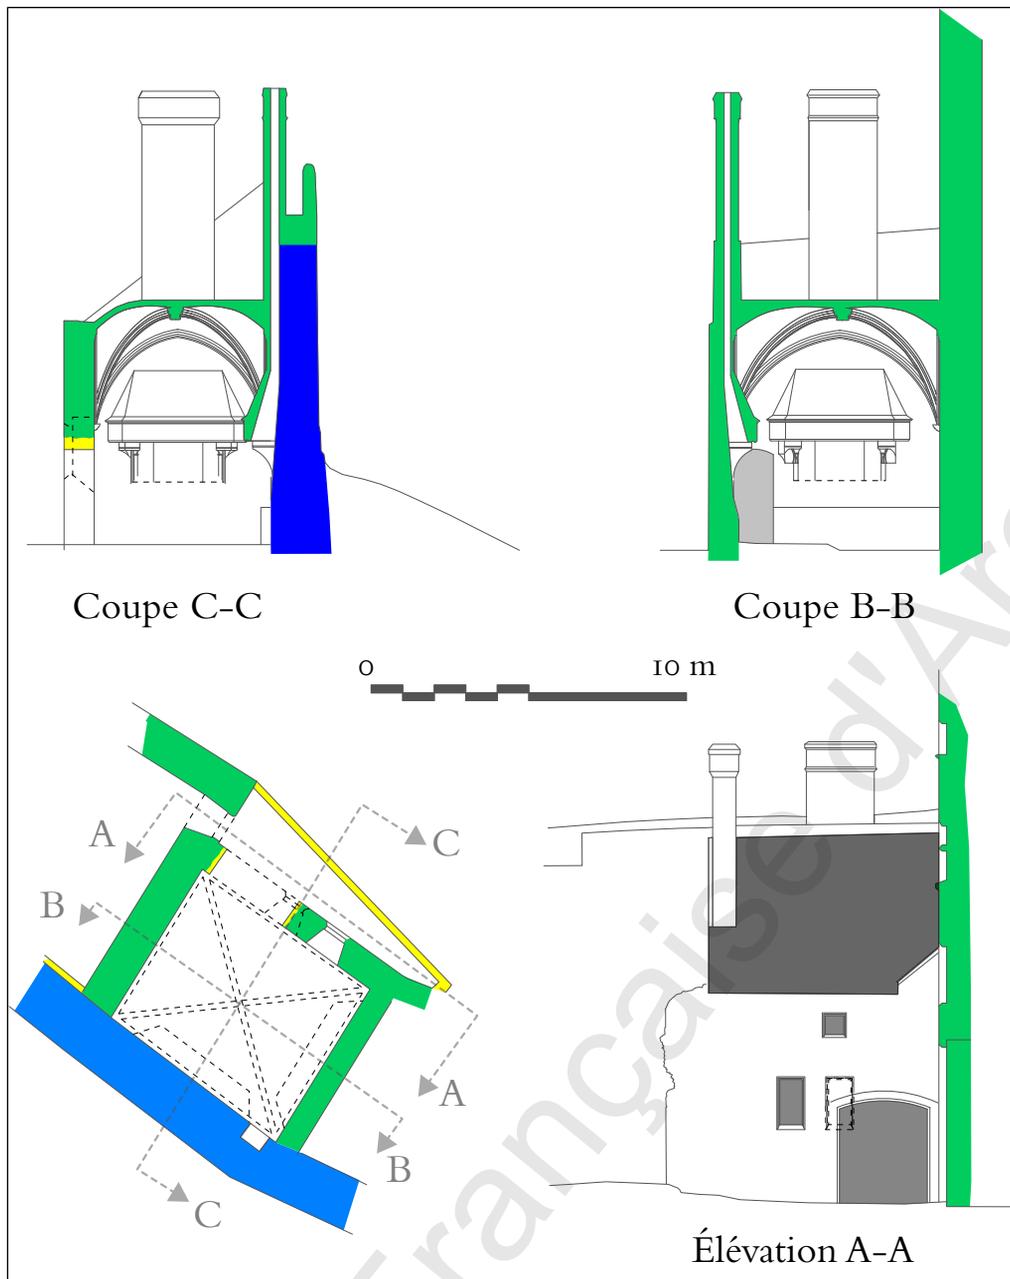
Montreuil-Bellay, château, plan, élévation et coupes de la vieille cuisine (dessin J. Mesqui 2022).
